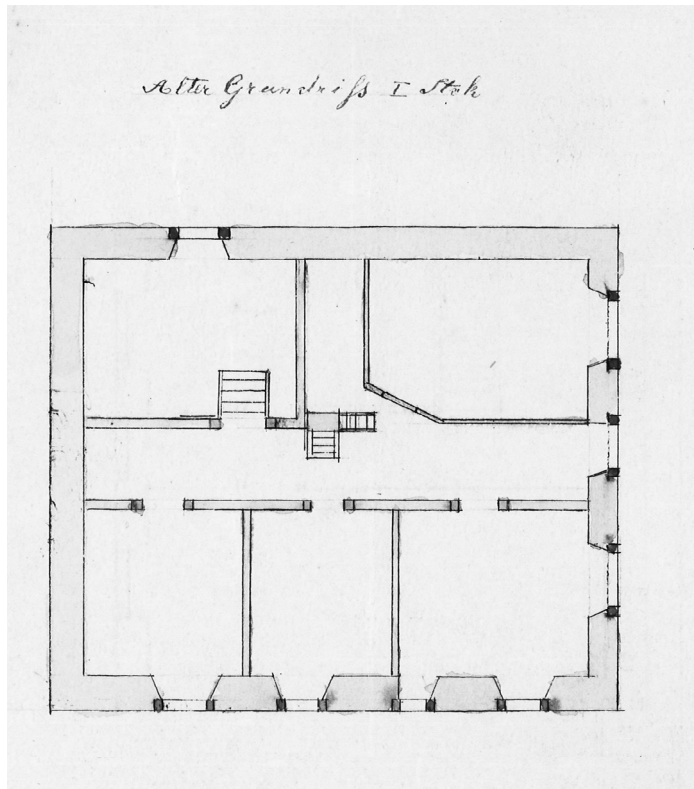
Kirchstraße 8, Grundriß Erdgeschoss, alter Bestand, Plan von 1886.
